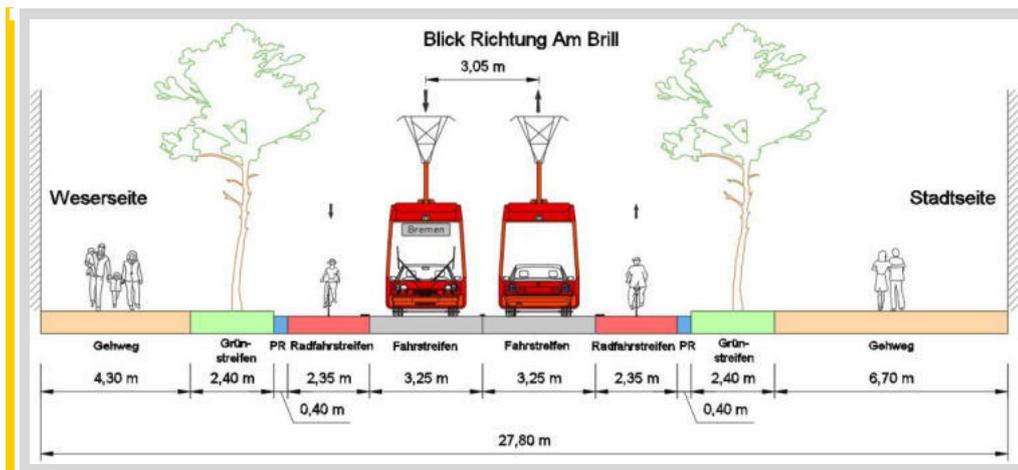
RQ 2 Planfall straßenbündiger Bahnkörper
